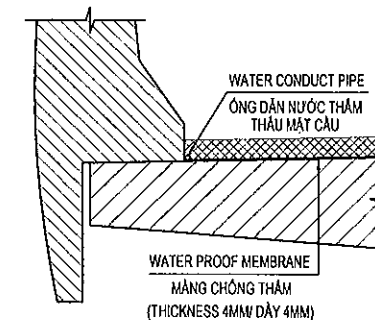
### DETAIL WATER CONDUCT PIPE AT EXPANSION JOINT CHI TIẾT ỐNG DẪN NƯỚC THẨM THẤU MẶT CẦU
